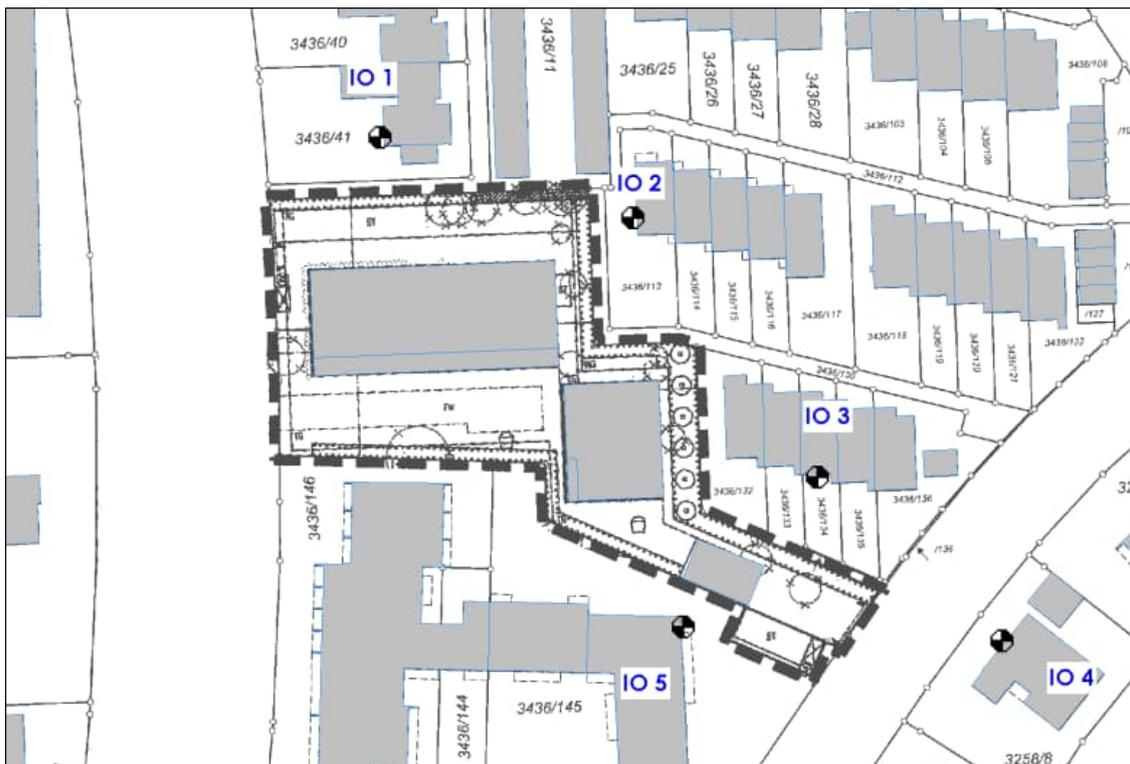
Lageplan mit Darstellung der maßgeblichen Immissionsorte IO
